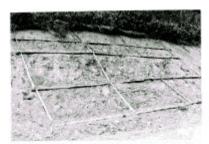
植教直後の実験林 No.2 植教試験地と循状 基礎工
